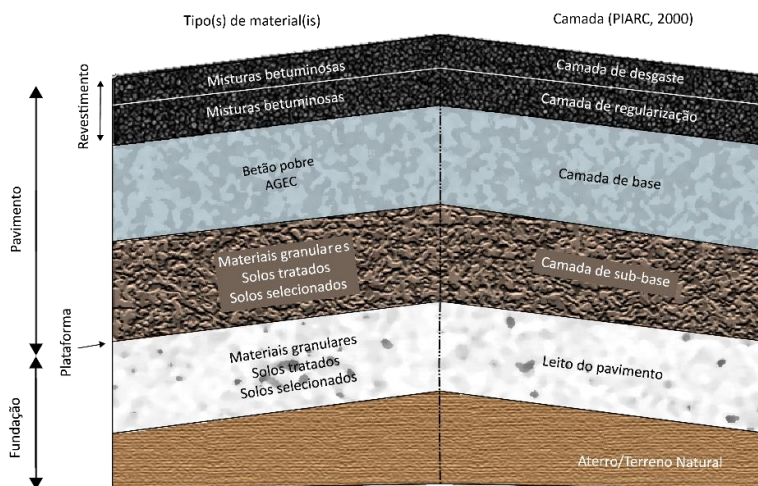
Constituição de um pavimento semirrígido (adaptado de ANTUNES, 2005)
